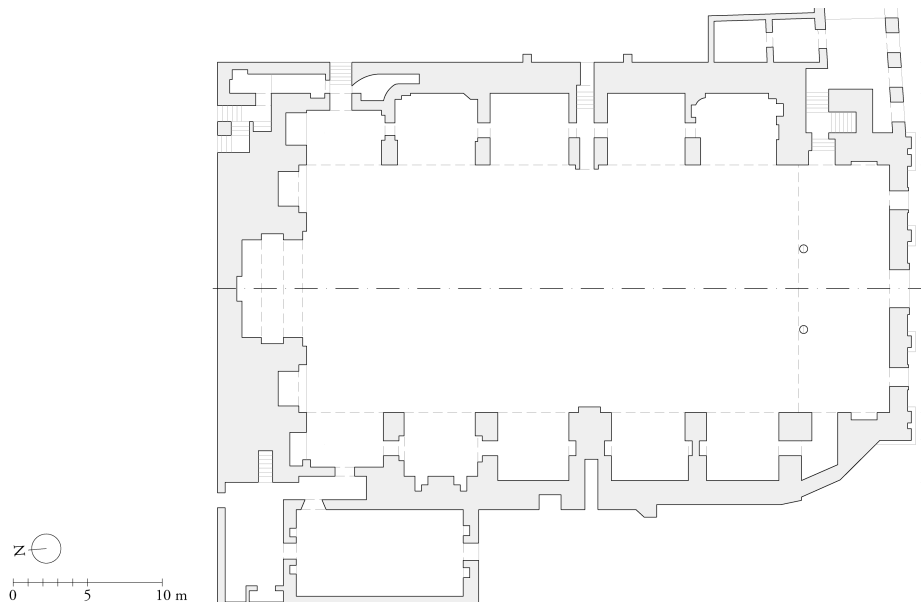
Planta da igreja de São Roque. Fonte do desenho base: (Pais & Mantas, 2010).
